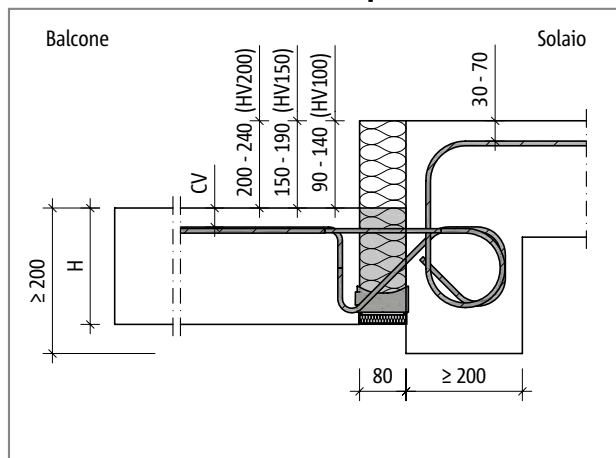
Schöck Isokorb® tipo K-HV, balcone con abbassamento e isolamento esterno
